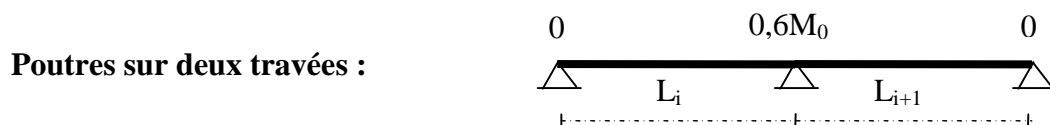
Schémas statique d'une poutrelle à deux travées.
